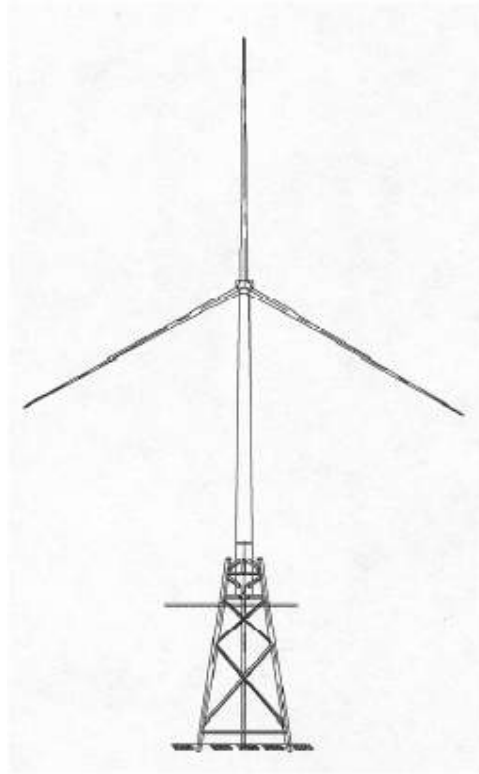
FUNDAÇÃO DO TIPO JACKET.
